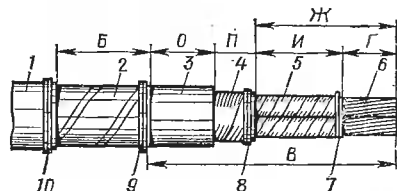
Размеры разделки кабеля: 1 — наружный покров, 2 — броня, 3 — оболочка, 4 — поясная изоляция, 5 — изоляция жил, 6 — жила кабеля, 7, 8 — бандажи из ниток, 9, 10 — проволоочные бандажи
